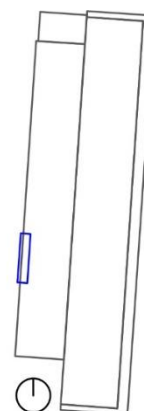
Individuazione del macroelemento in prospetto e pianta
